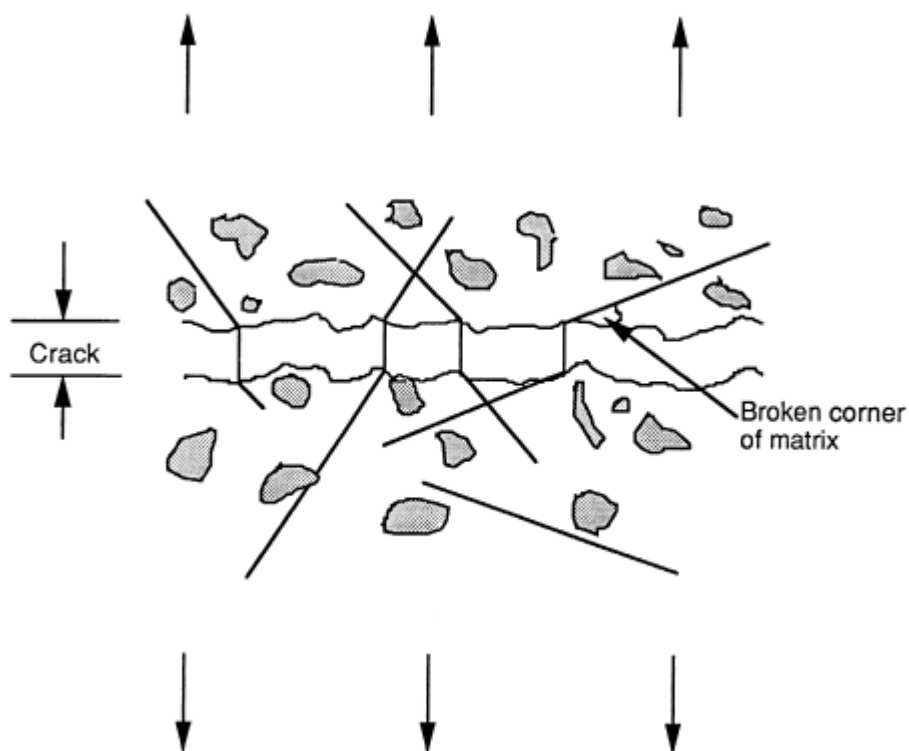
Inclinazione delle fibre rispetto alla fessura. [D.J. Hannant, 2000]
